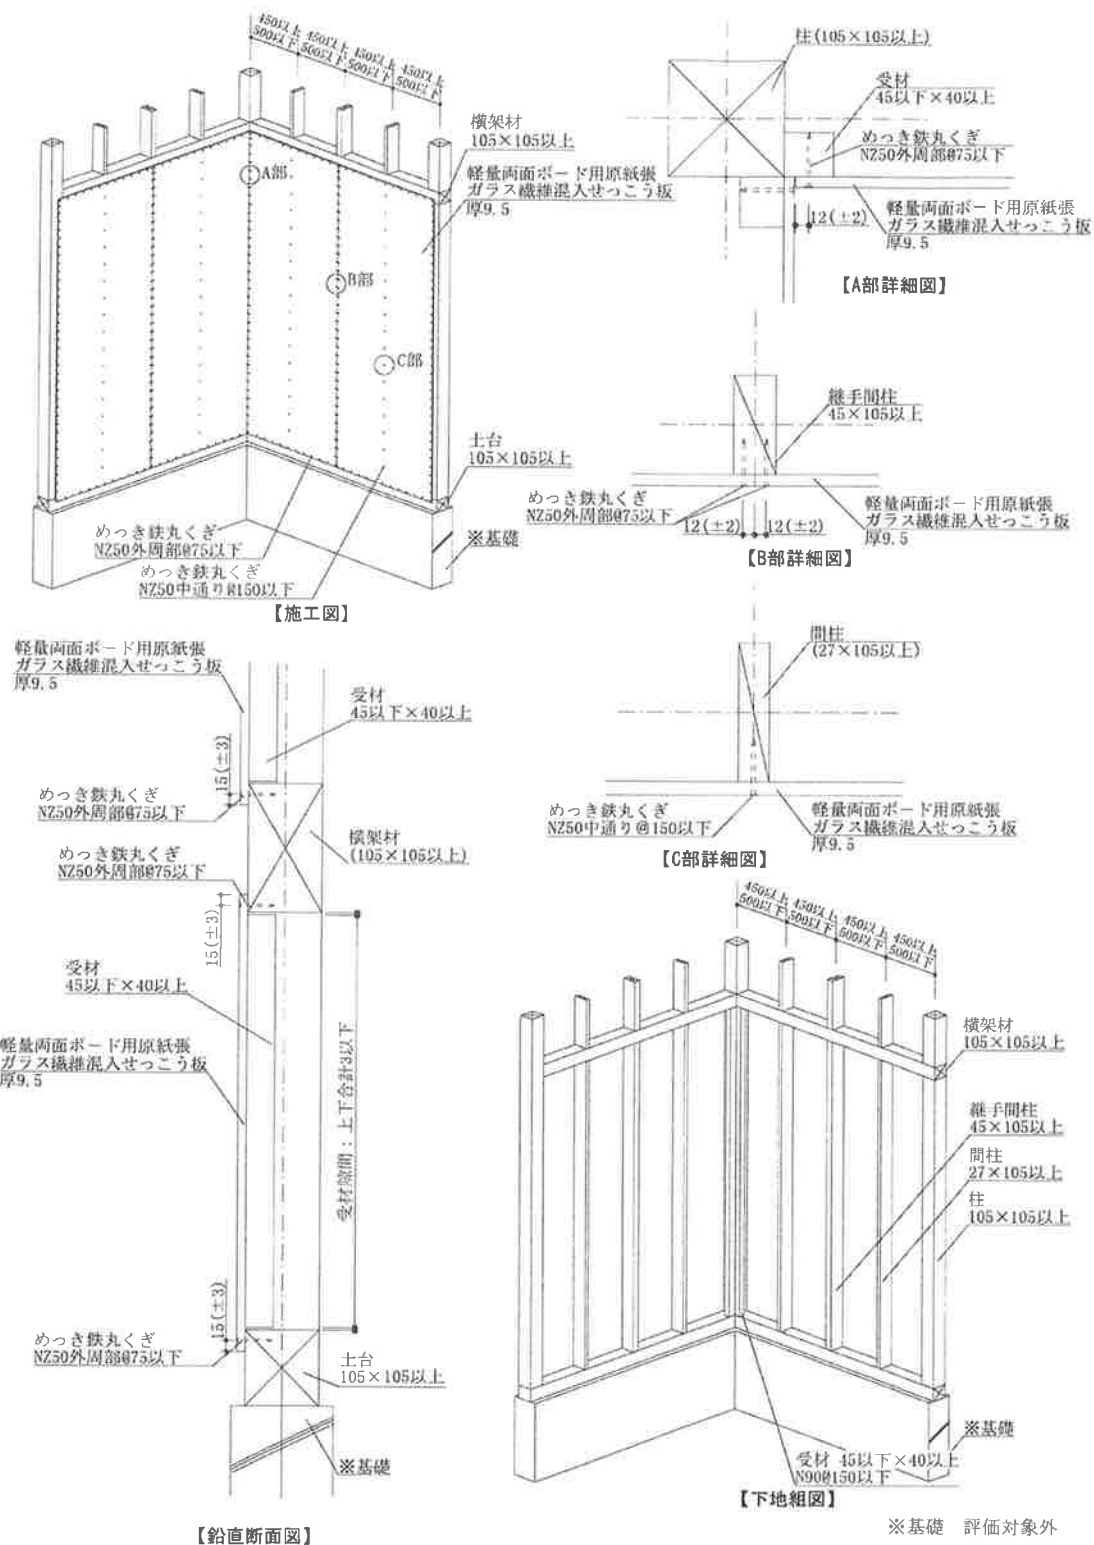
施工詳細図：1枚張りの場合 (寸法単位：mm)
